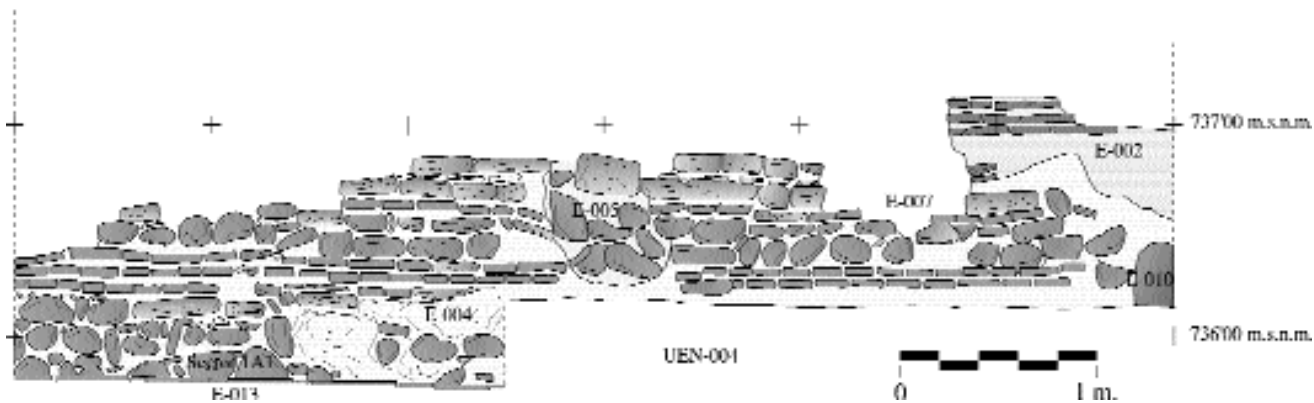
Alzado del muro de la crujía norte estancia nazarí (E-004).
